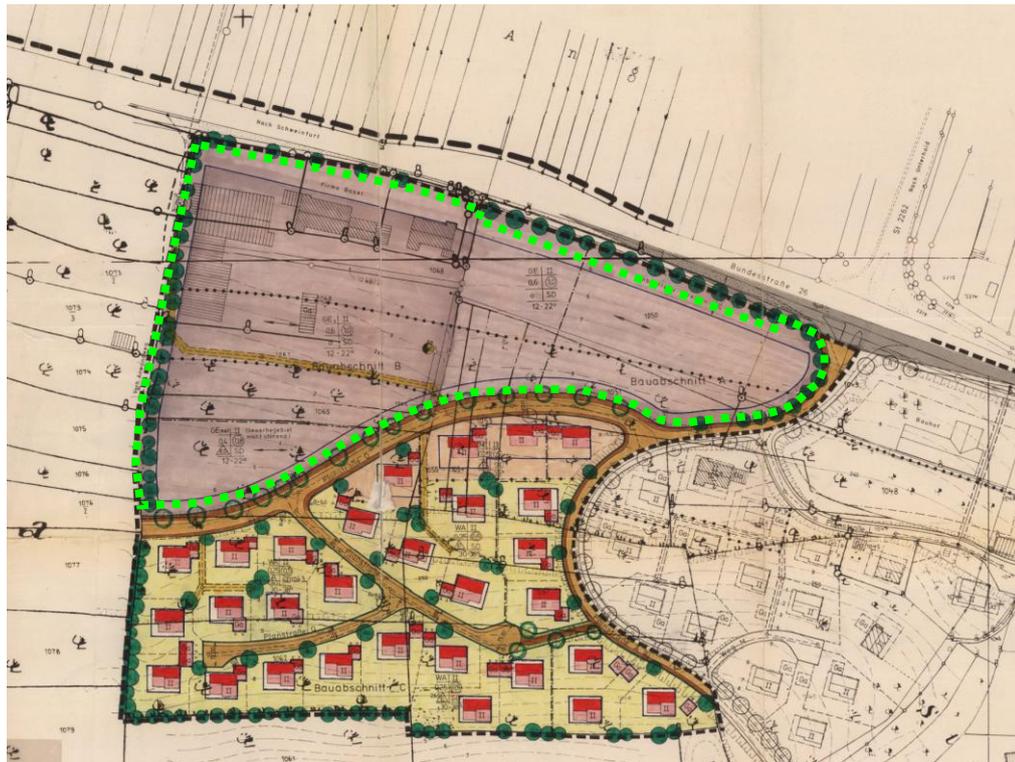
Ursprünglicher Bebauungsplan Viereth „West“
